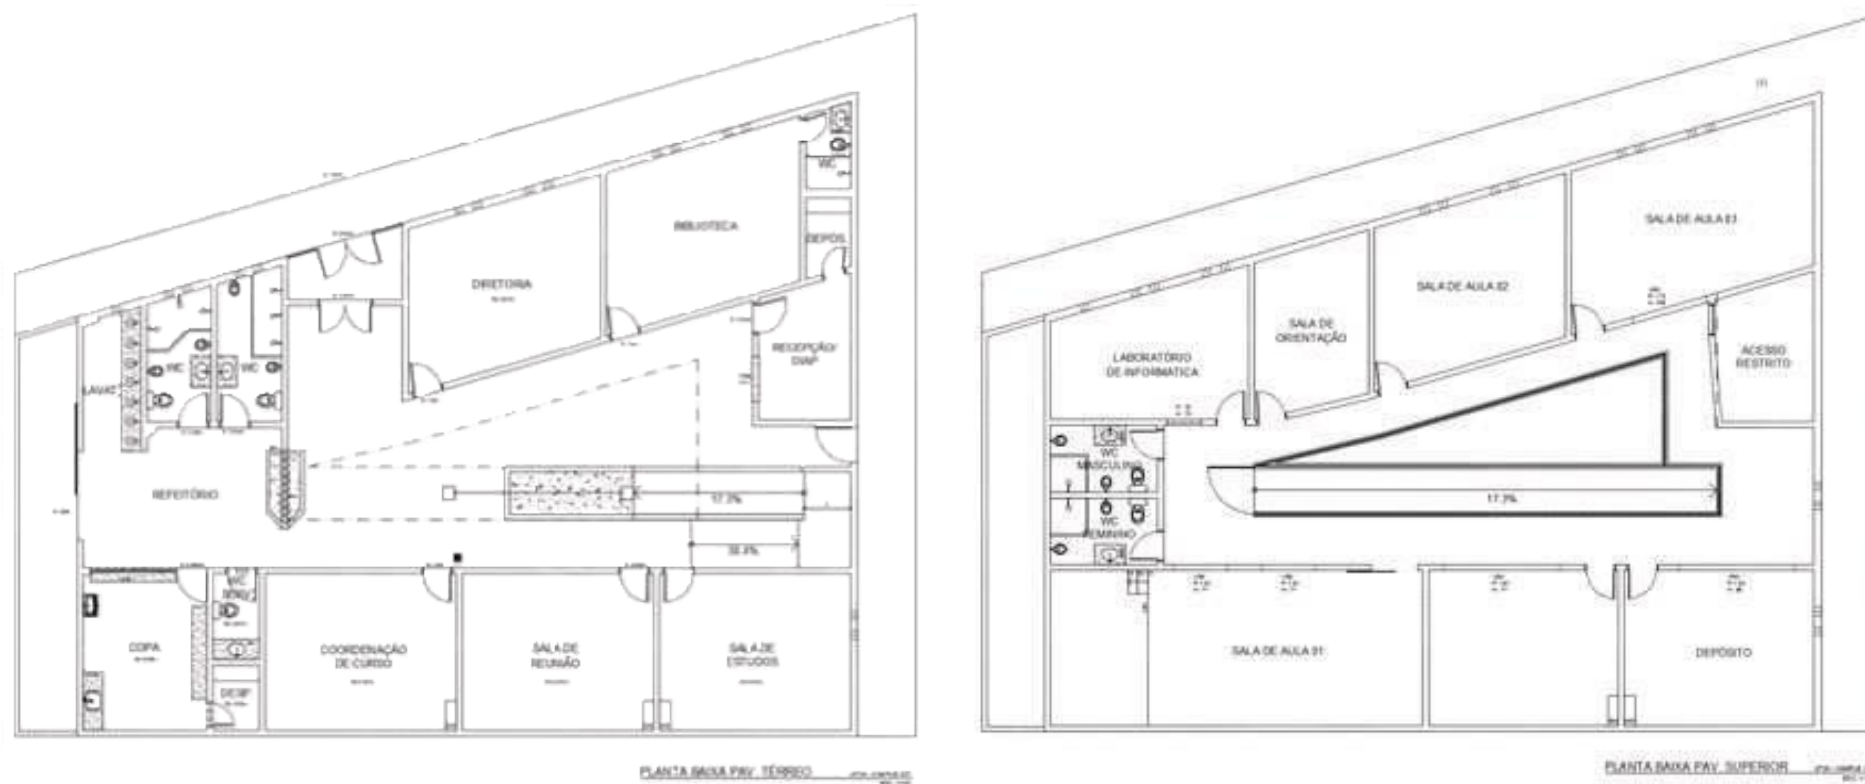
Campus Icó - Plantas Baixa do Pavimento Térreo e Primeiro Andar
